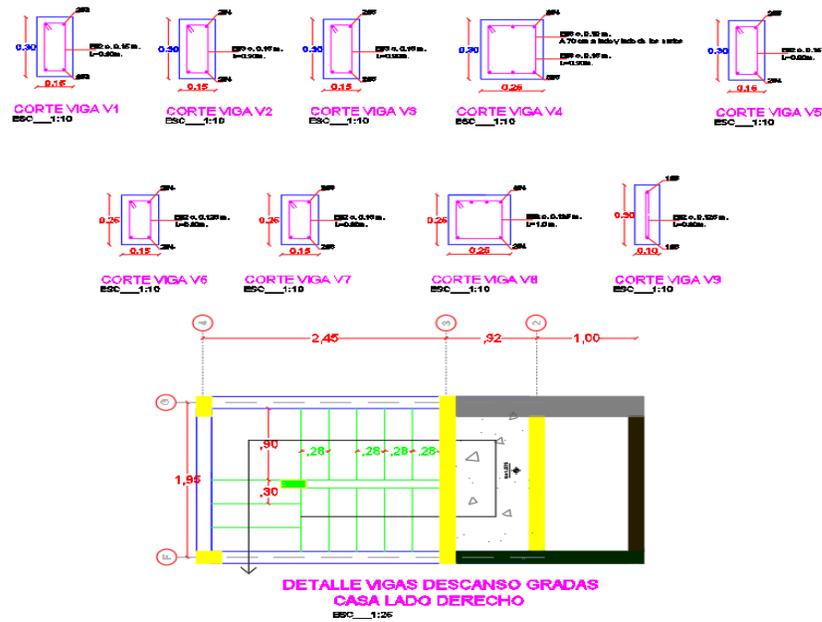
Detalles de tipos de vigas. Fuente Diseño Ing. Carlos Ariel Hurtado.
